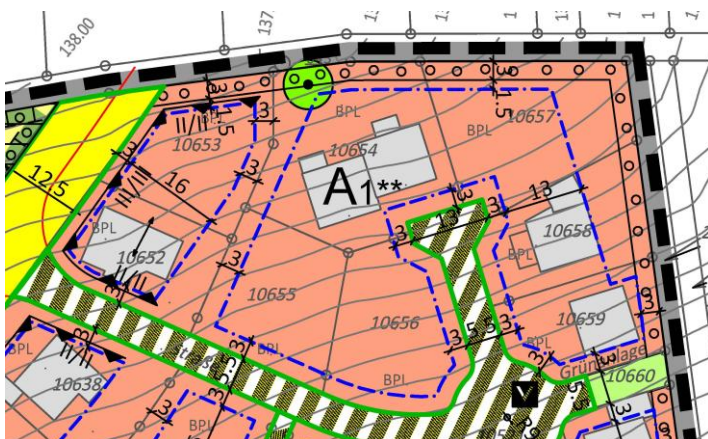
Geänderte Baufensterfestsetzung im Nordteil des Bebauungsplanes
